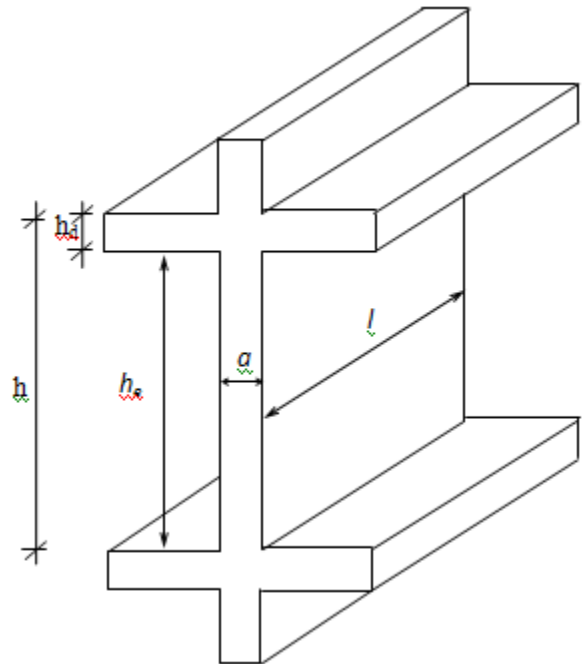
Coupe d'un voile en plan contreventement en élévation.
